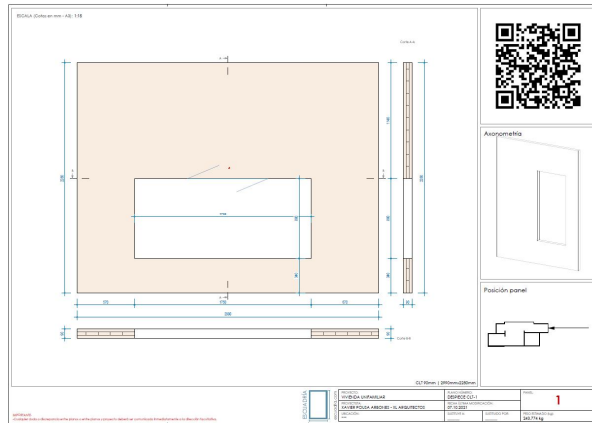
Plano de despiece de un panel de pared La generación de planos de despiece debe ser siempre completamente automática.
